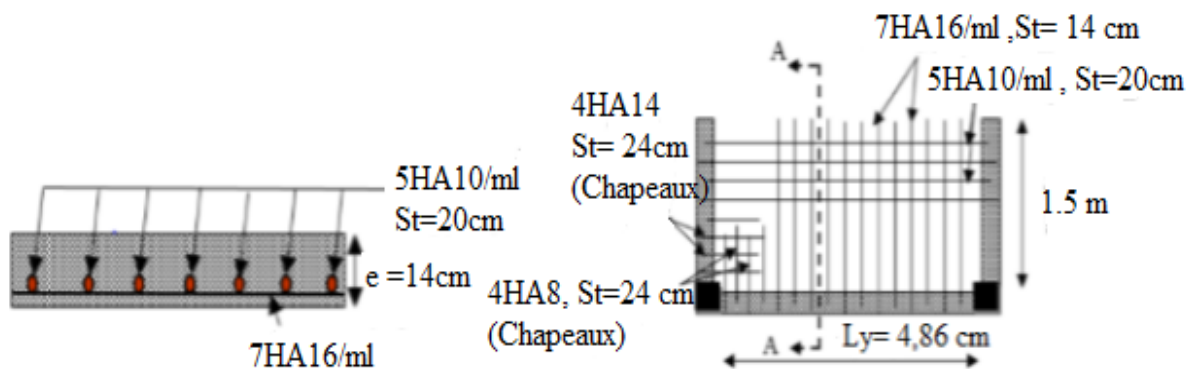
Schéma de ferrailage de la dalle sur 3 appuis (balcon étage courant)
